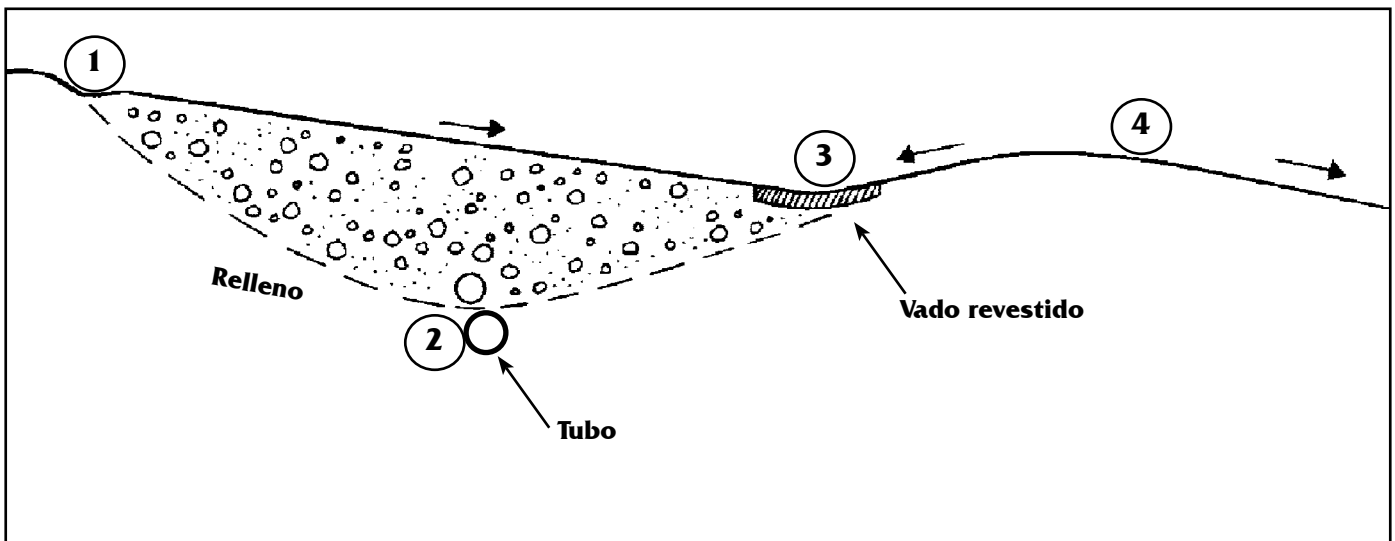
Protección de Alcantarillas contra desbordamiento.
